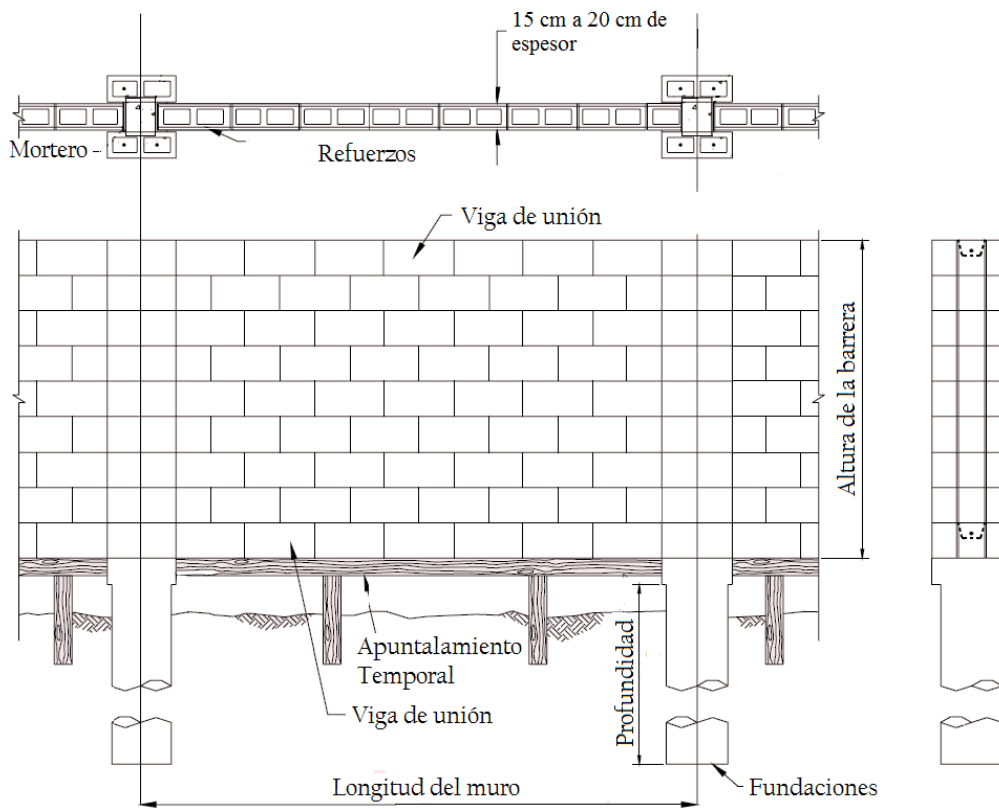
Esquema constructivo de barrera sónica con bloques de mampostería de hormigón.
